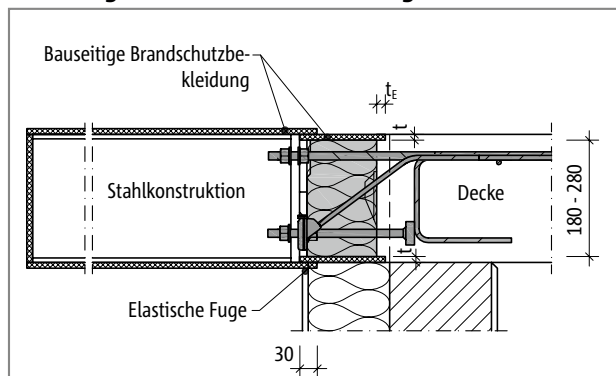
Schöck Isokorb® XT Typ SK: Bauseitige Brandschutzbekleidung für den Isokorb® und die Stahlkonstruktion; Schnitt
